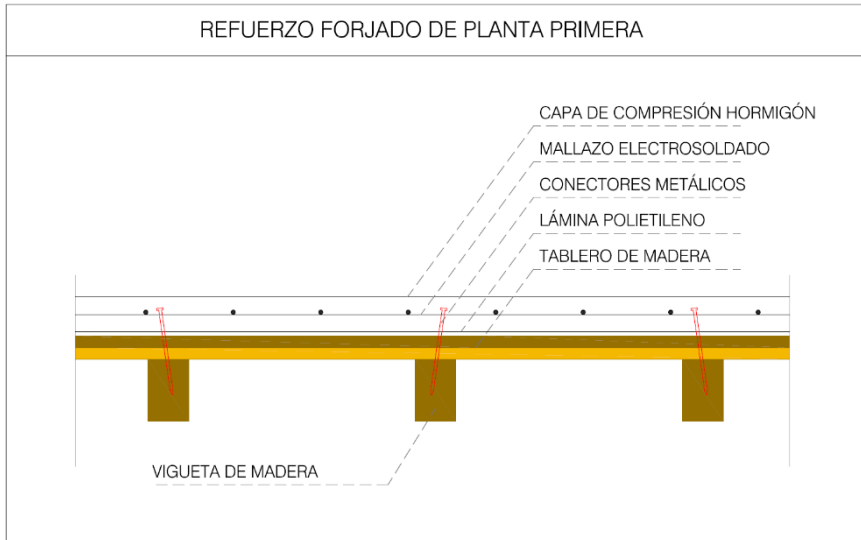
Detalle de refuerzo de forjado de madera. 2023. Fuente: propia
